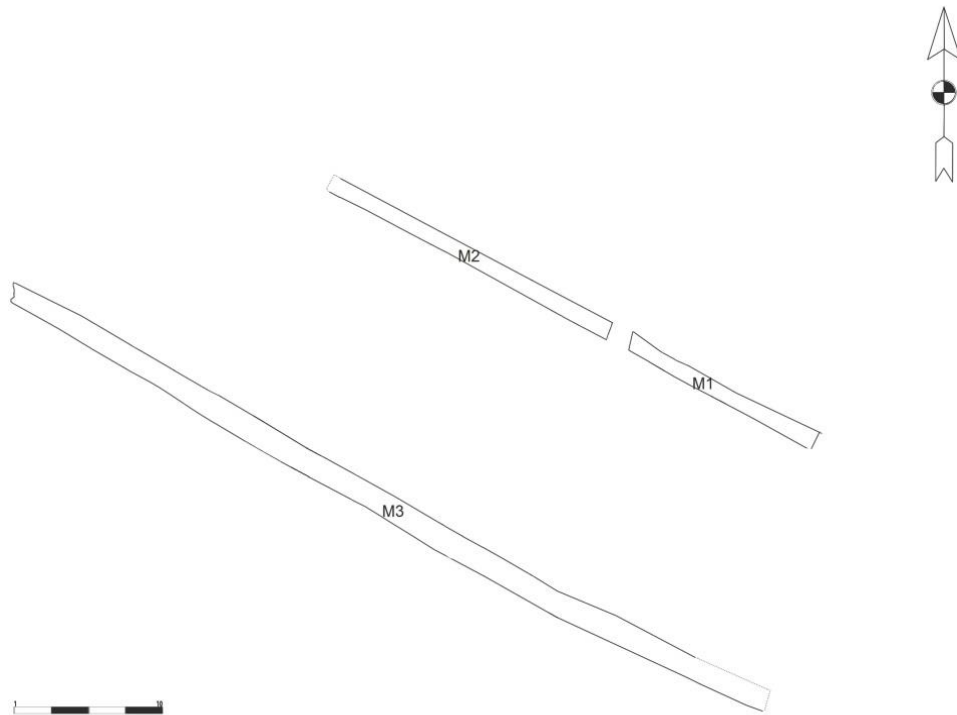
(2).- Fase constructiva 1: planta
